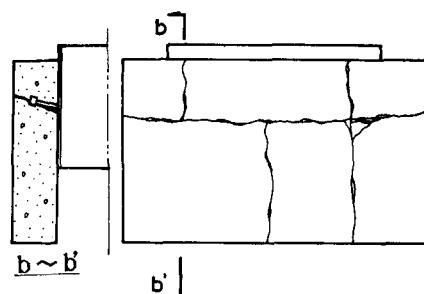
コンクリートの破壊状況とスタッドジベルの変形状況
